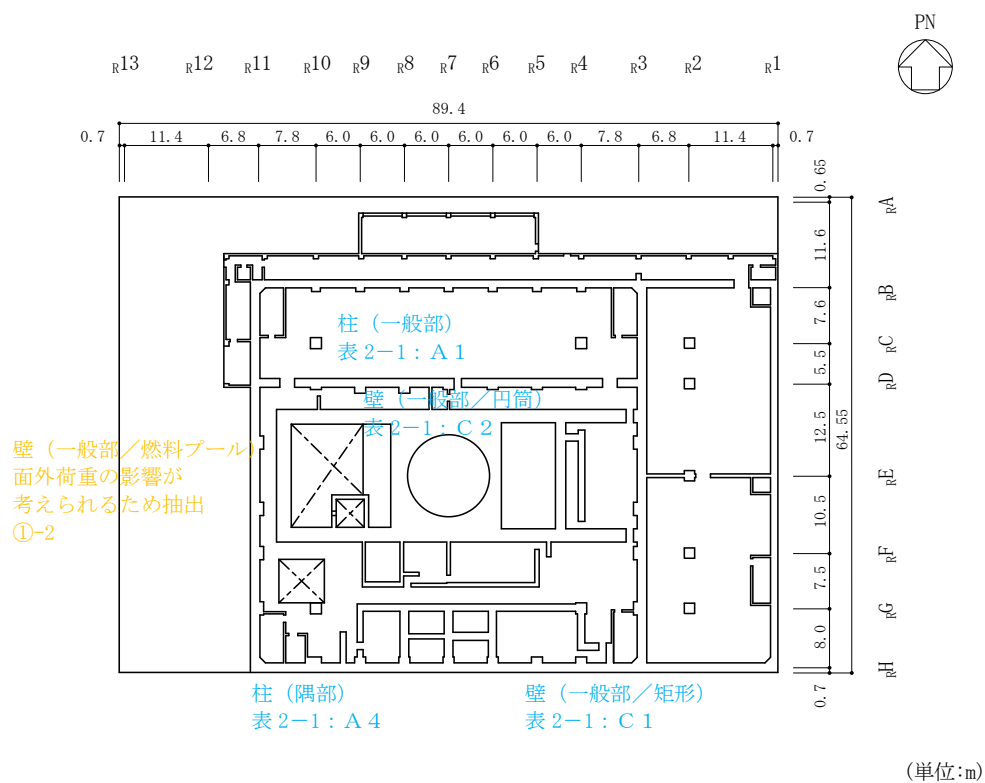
(6) 原子炉建物の概略平面図 (EL 34.8m)
